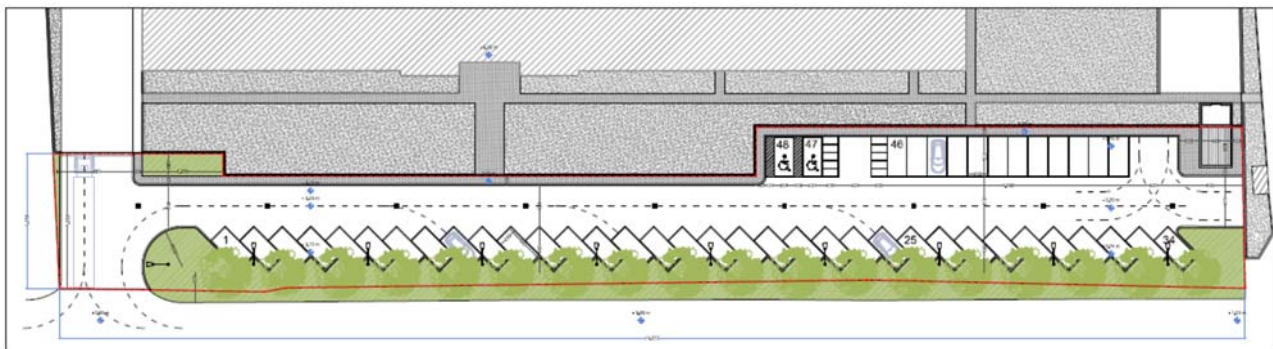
Estratto della planimetria della zona pubblica (il perimetro è individuato dalla linea rossa)
